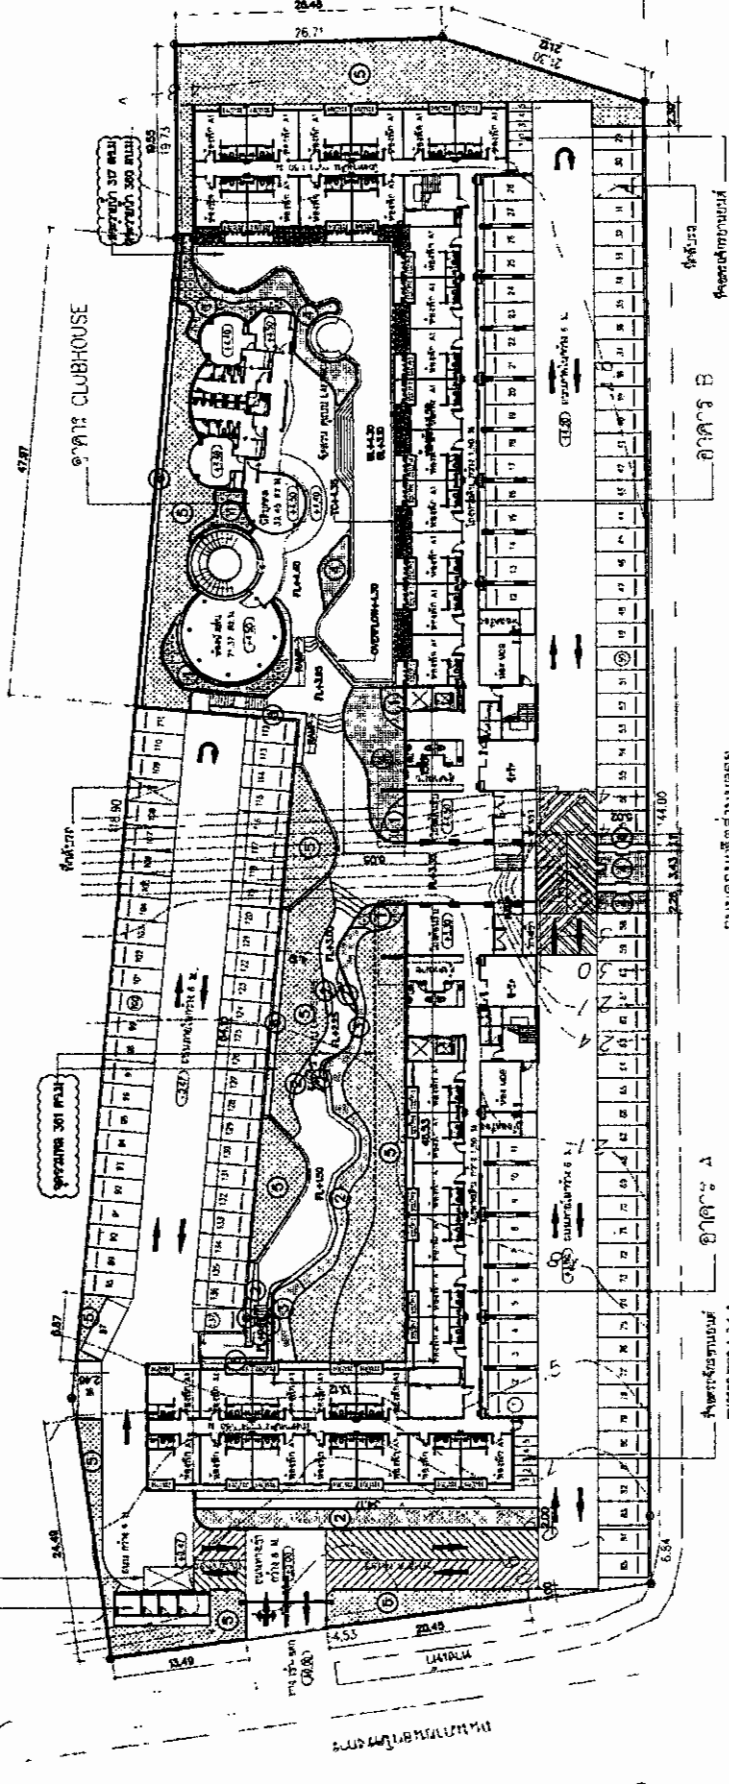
ผังแสดงชนิดพันธุ์ไม้ยืนต้นที่ปลูกบริเวณชั้นต่างๆของโครงการ
